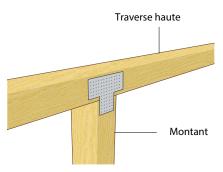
Exemple de renforcement des jonctions au droit des montants
